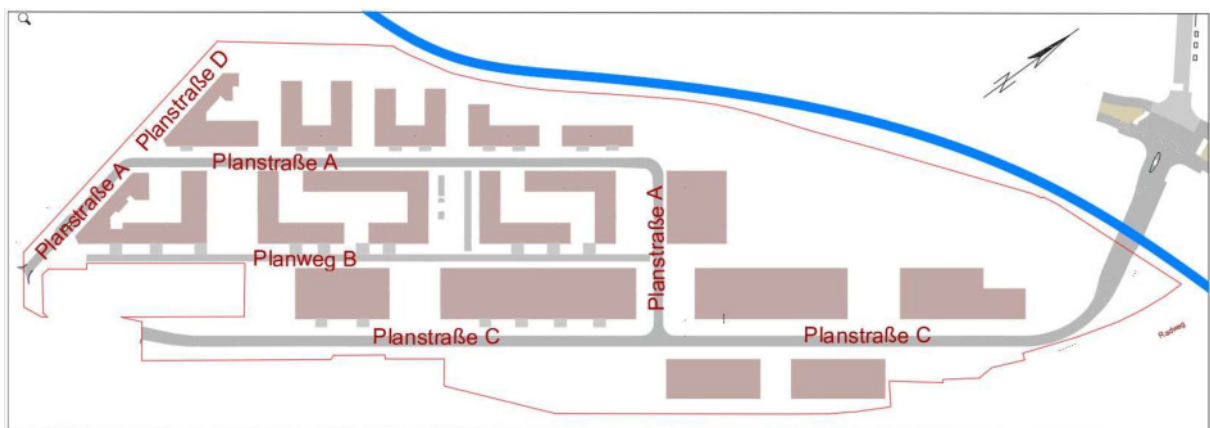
Darstellung des Erschließungsgebietes mit Lage der Gebäude und geplantem Straßenverlauf
